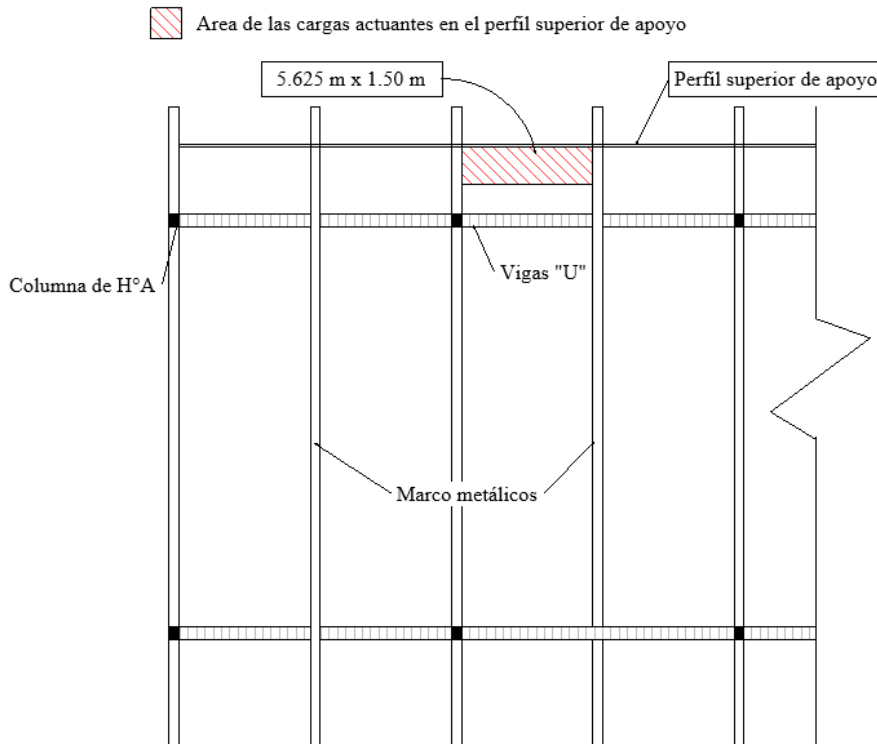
Vista en planta de superficie de carga actuante sobre perfil superior. Fuente: Autor.
